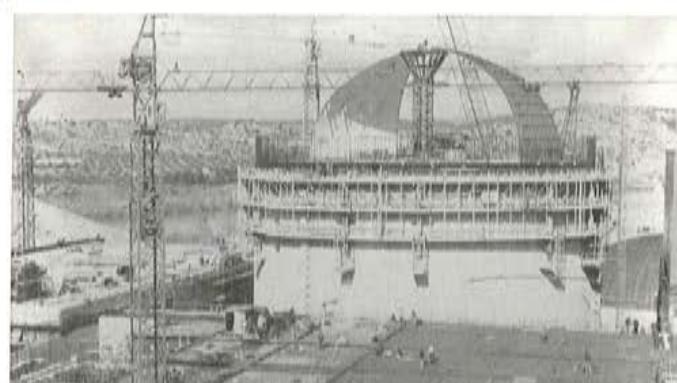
Encofrado Trepante para el muro del Ed. Contención.
